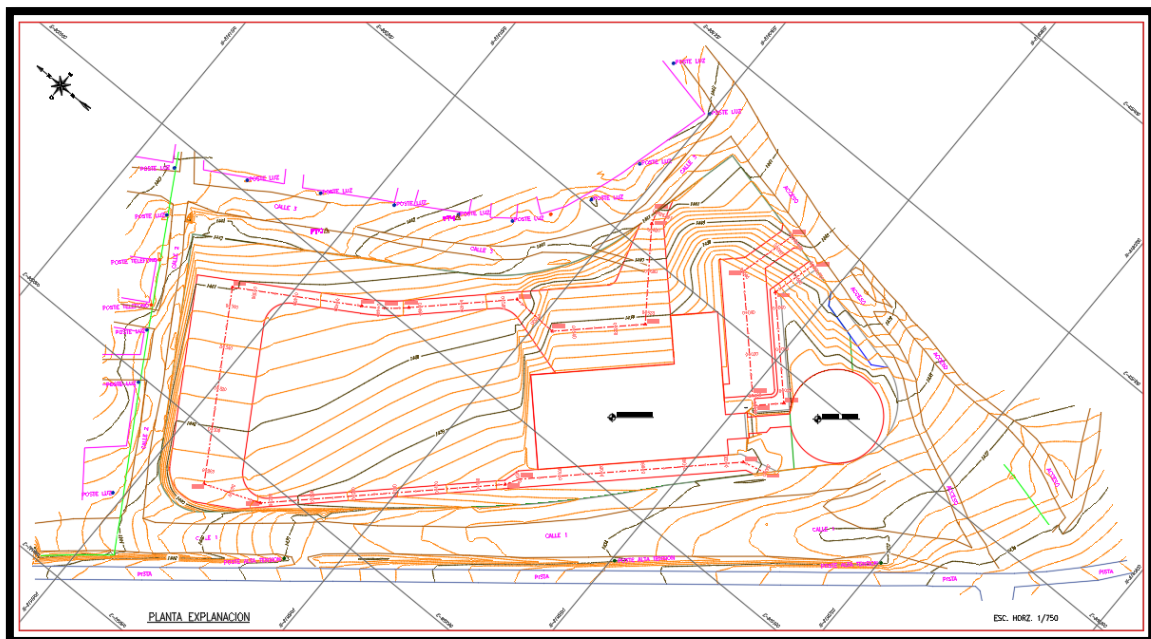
BASE GRANULAR. Plano de planta de pista - componente V.
